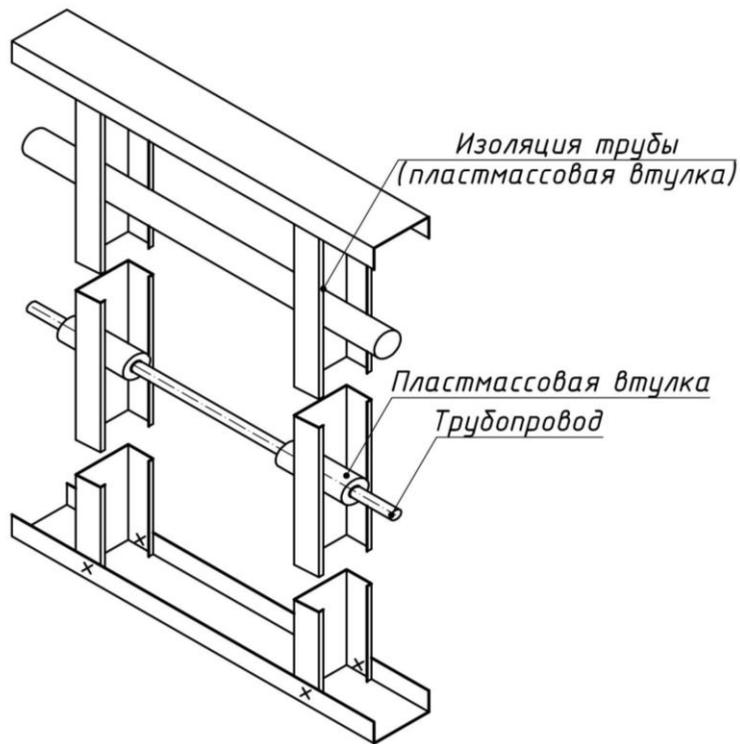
Узел Д 1. Прокладка и монтаж трубопроводов
